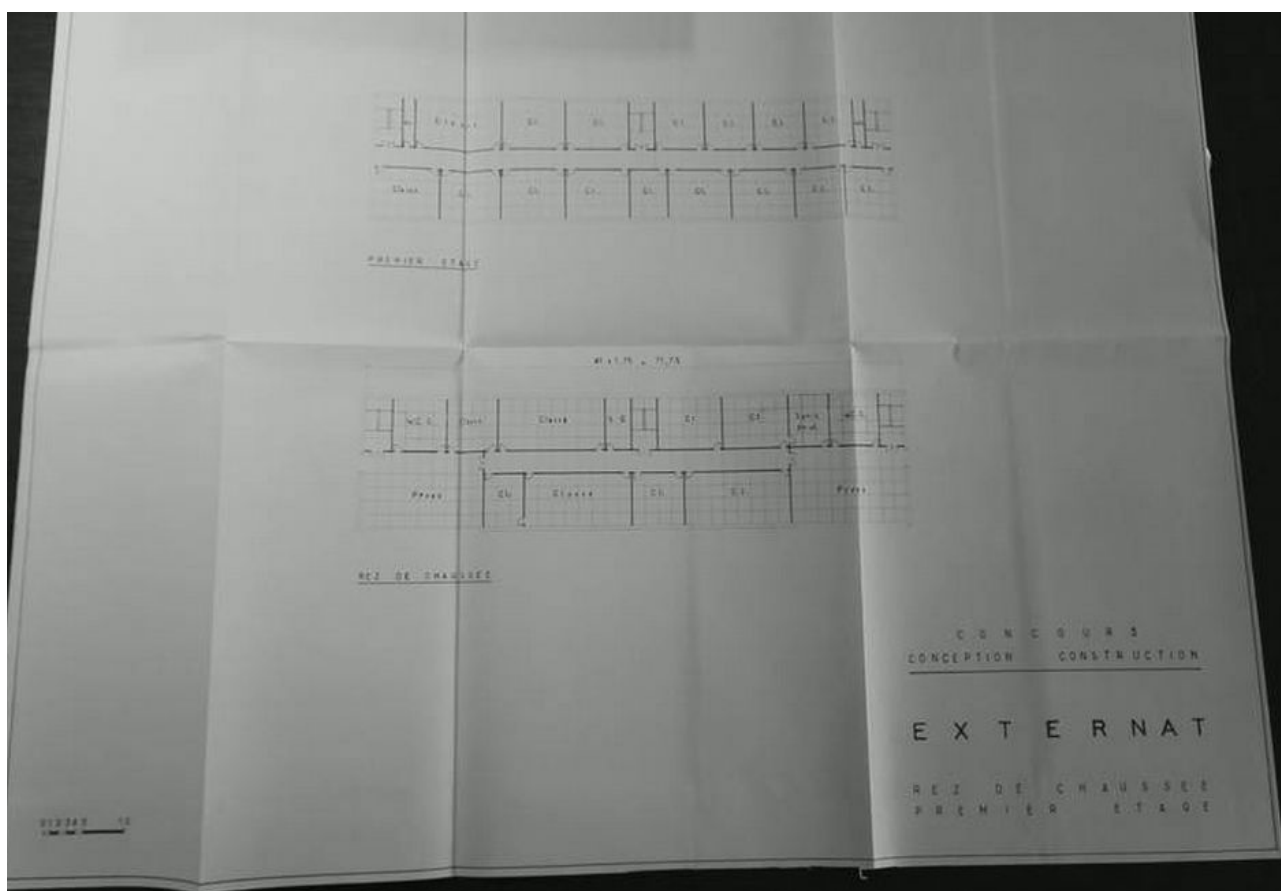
Plan de l'externat issu du concours conception-construction lancé par le MEN.
